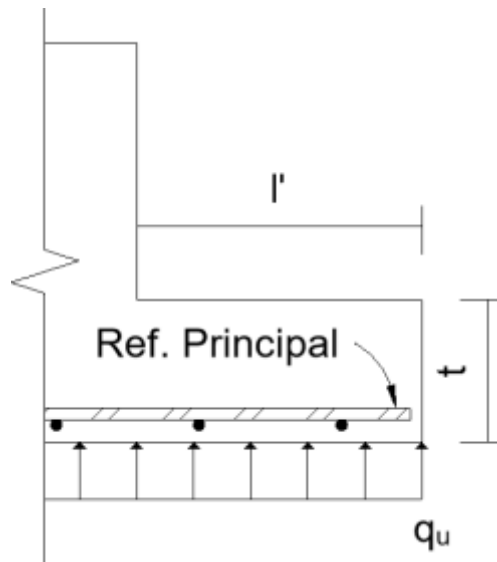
Detalle del refuerzo longitudinal en la zapata. [Elaboración propia]
